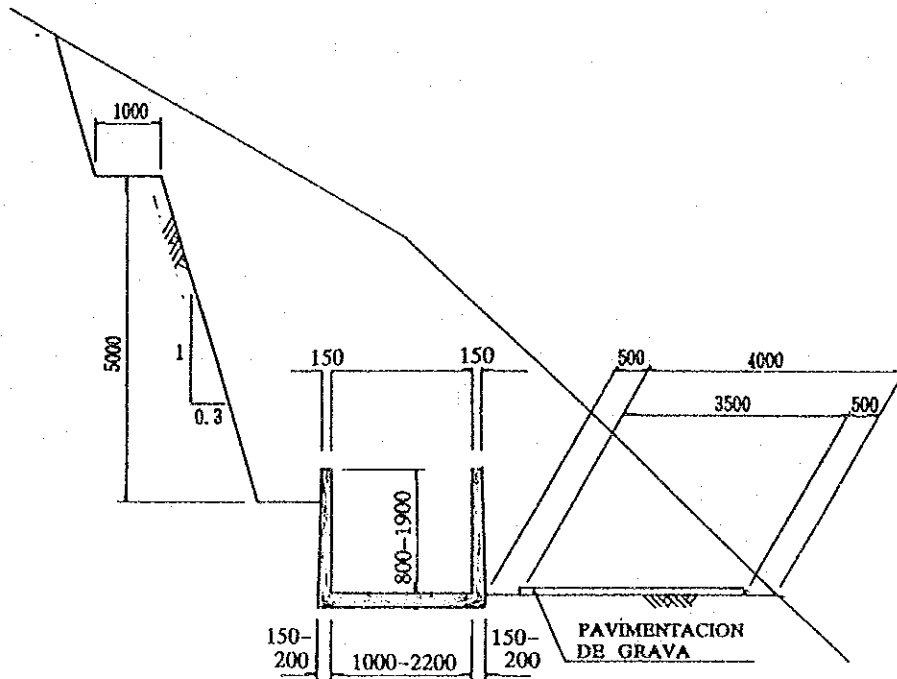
Sección Típica de Canal Abierto (Canal Principal)
